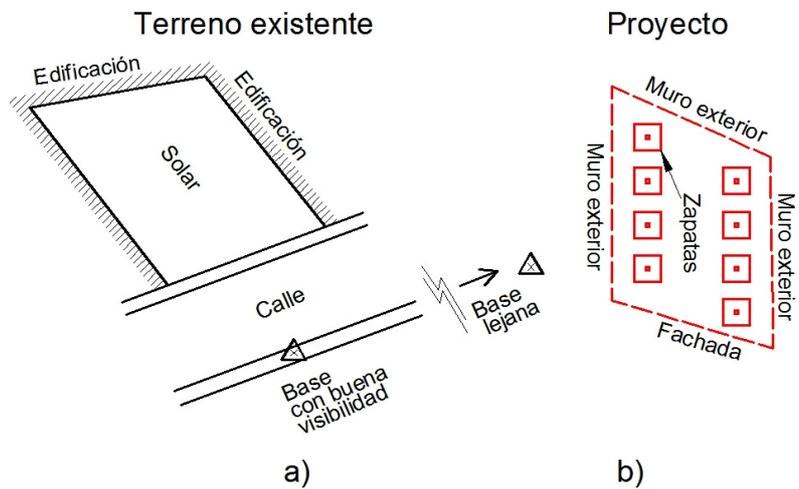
“Encaje” de un proyecto de edificación en el terreno
